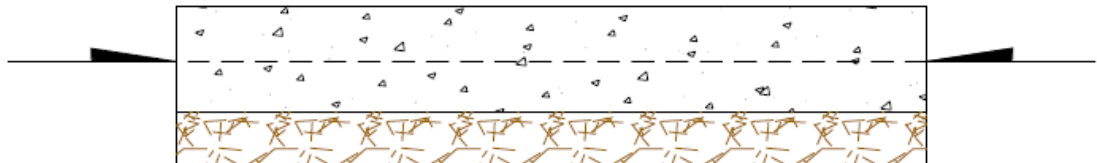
D Sección Longitudinal de un Pavimento típico de concreto Preesforzado.
